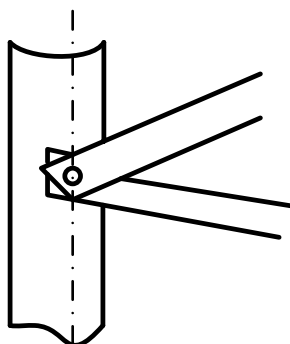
Узел крепления раскосов к поясам одним болтом
